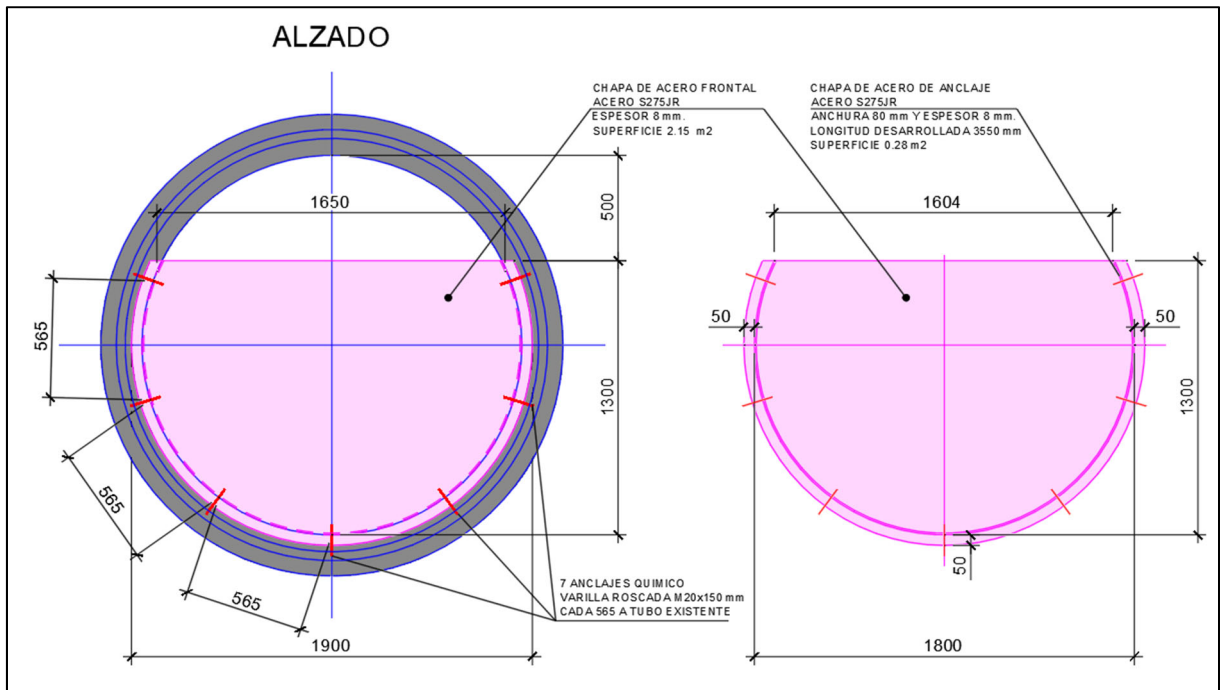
Alzado de la chapa de acero para la reducción de la sección de la conducción existente.
